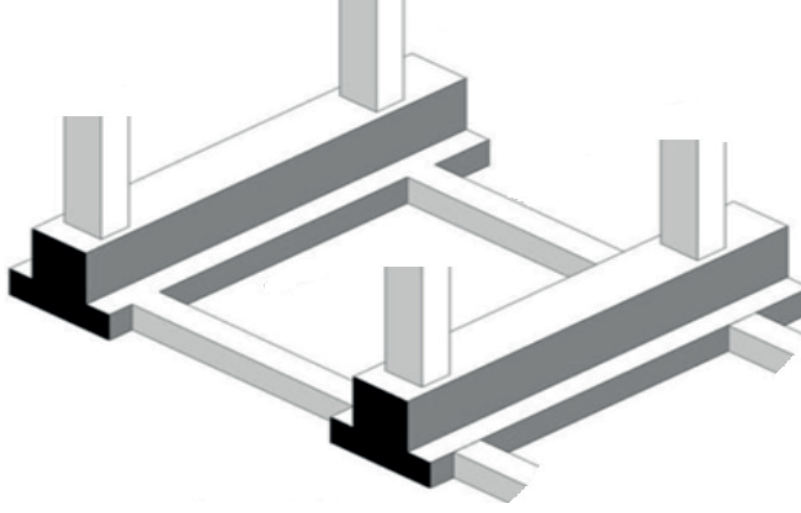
Betonarme tekil temel sistem kesiti detay krokisi
